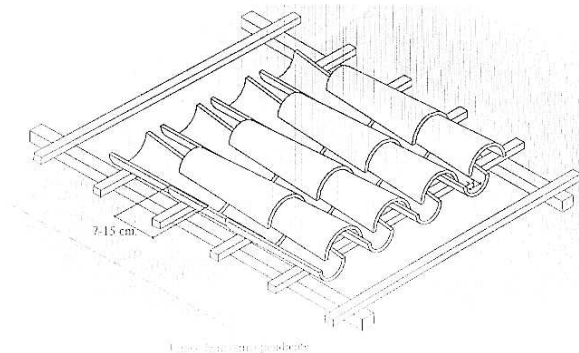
Colocación de teja a teja vana. Fuente: Guía de diseño y ejecución en seco de cubiertas con teja cerámica. <https://activatie.org>
